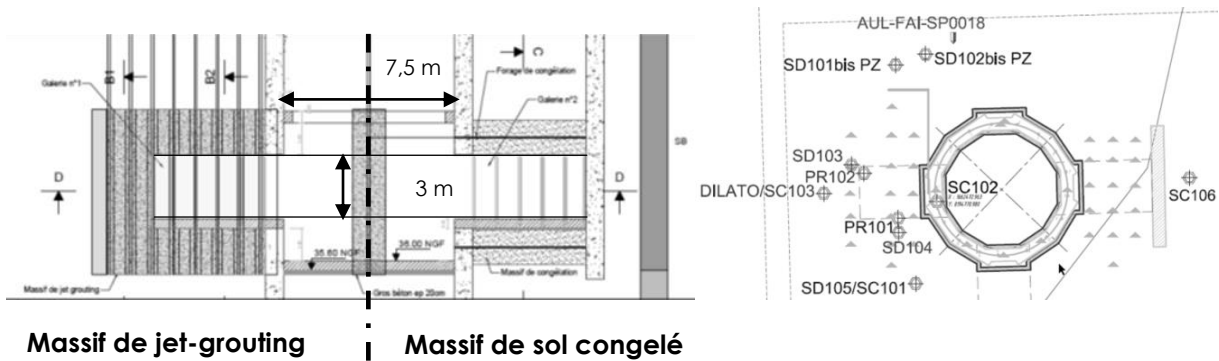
Coupe du puits d'essai (à gauche) et plan des reconnaissances et investigations géotechniques réalisées sur le puits d'essais (à droite).
